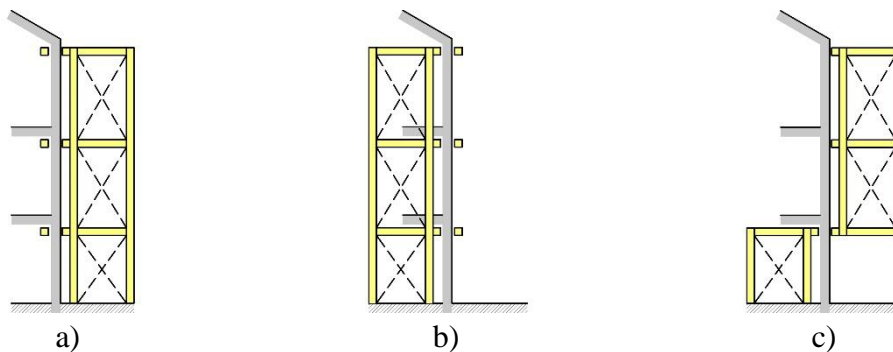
Localização das estruturas de contenção: a) estrutura externa; b) estrutura interna; c) estrutura mista
